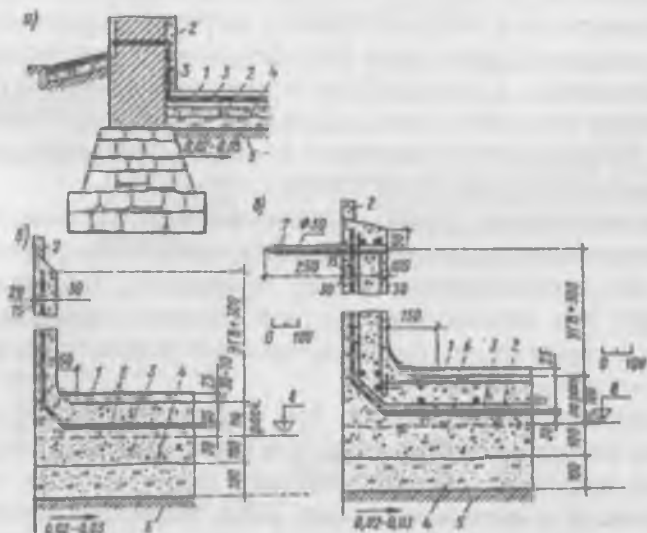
Конструкции гидроизоляции стен и пола помещений, заглубленных в земле:
